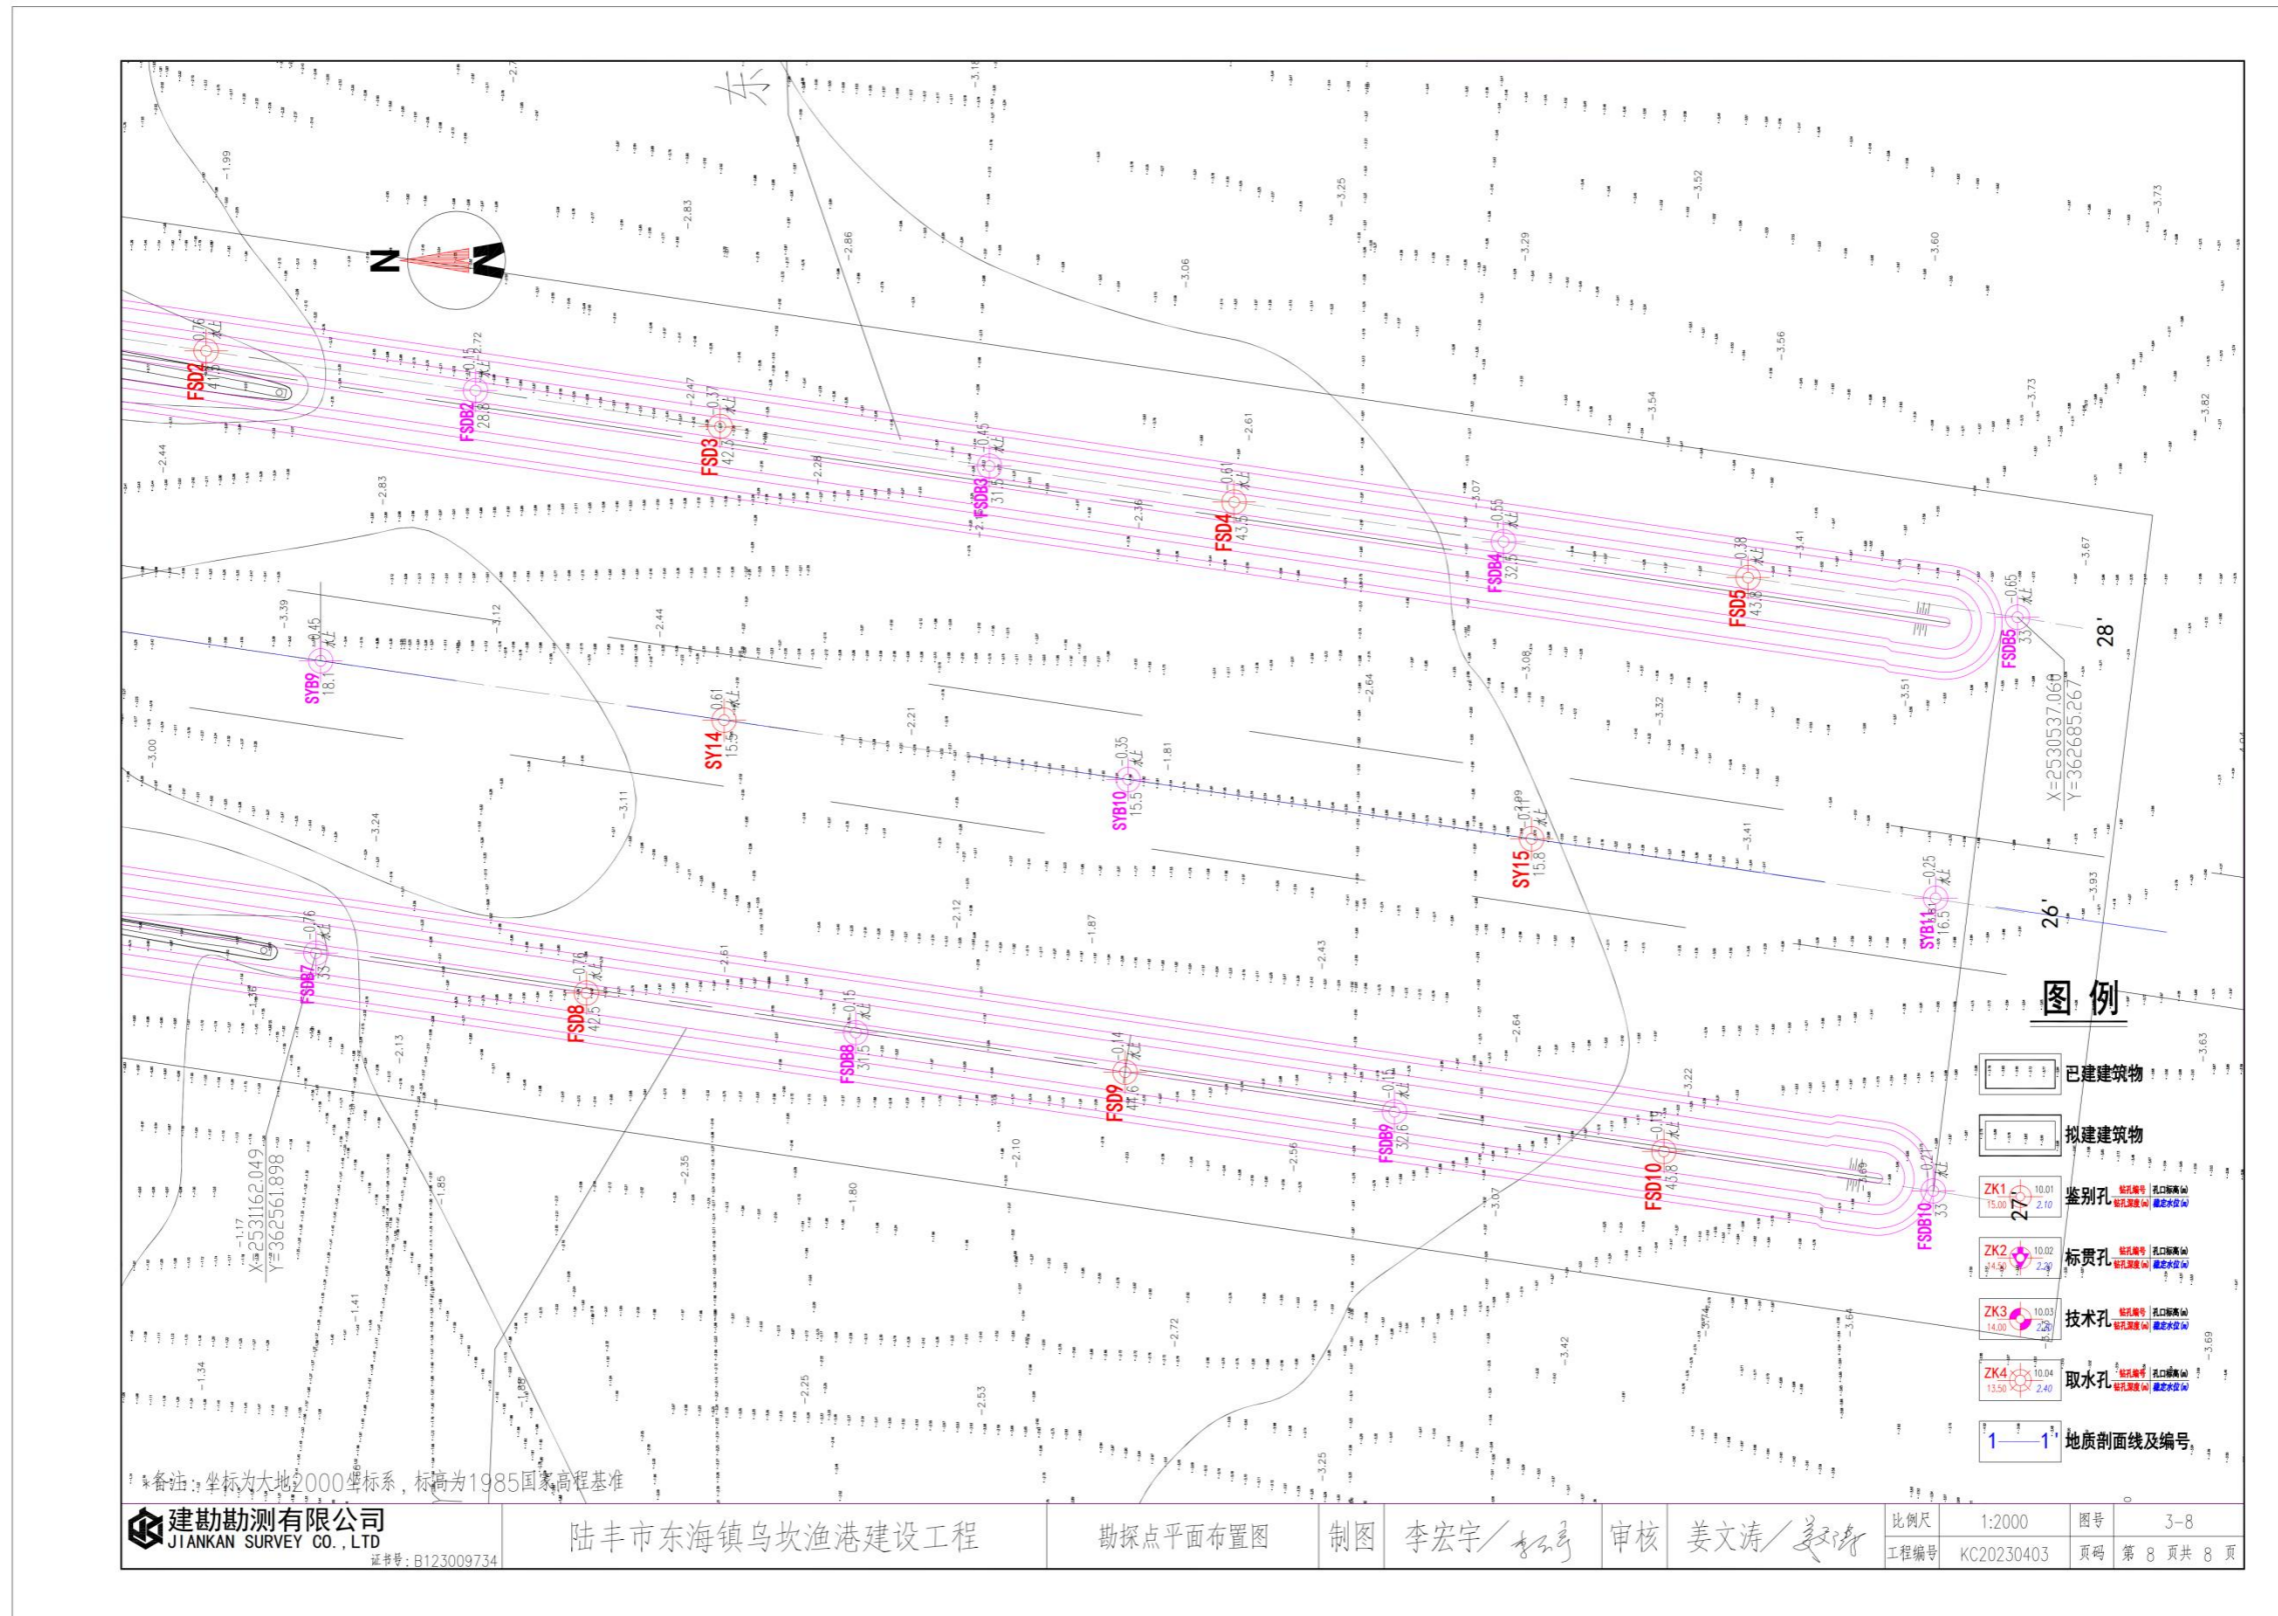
项目地质勘察钻孔平面布置图 (2)
